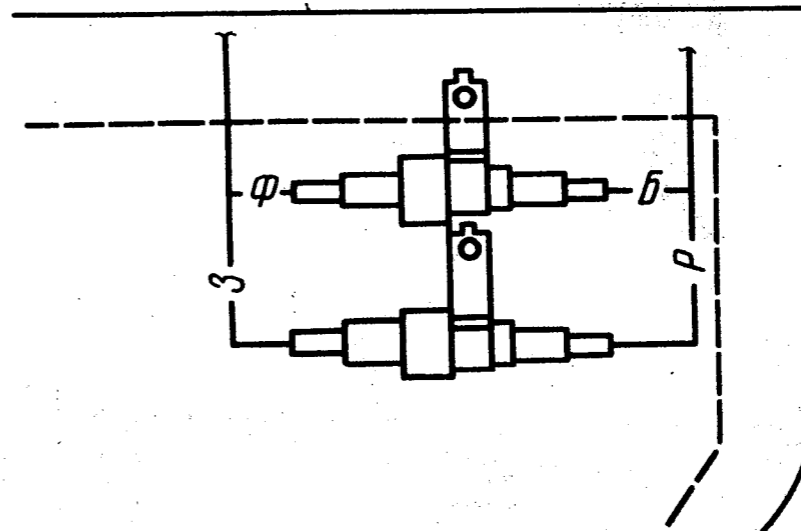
Монтаж проводов к предохранителям на левой боковине
